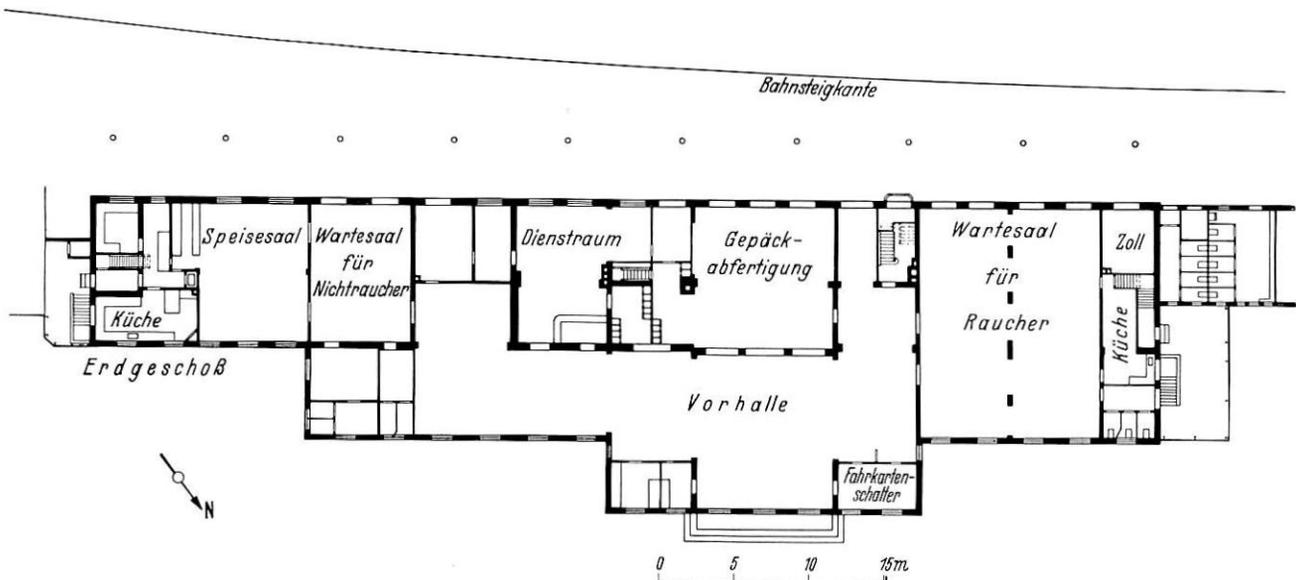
Empfangsgebäude Randers vor dem Umbau.
